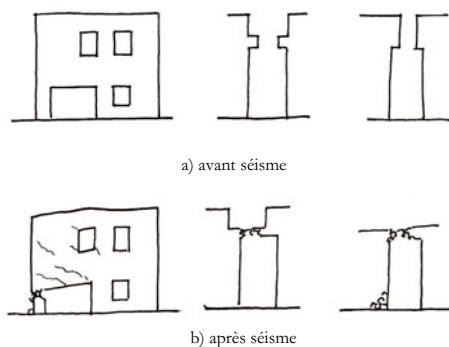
Rupture au droit d'un changement brutal de section d'un élément participant au contreventement
